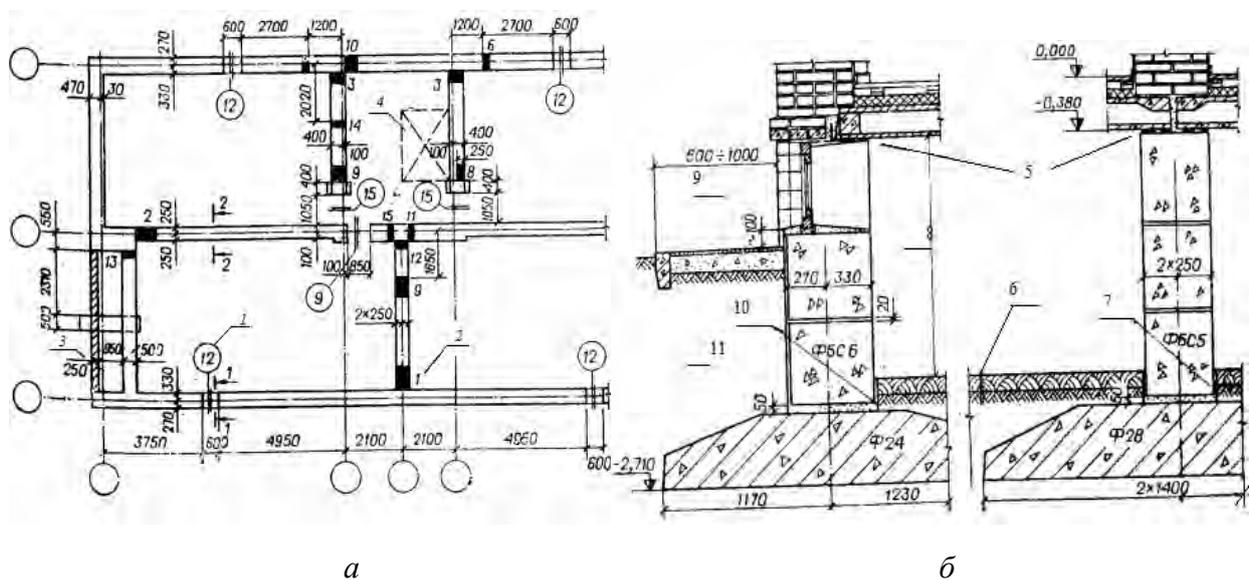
Сборный блочный ленточный фундамент: *а* — план стен технического подвала (подвала); *б* — сечения фундаментов (при уровне грунтовых вод ниже пола подвала): 1 — марки перемычек; 2 — марки отверстий; 3 — кирпичный доколь по ж/б балке; 4 — габарит шахты лифта; 5 — 2 слоя толя или гидроизола на битумной мастике; 6 — глинобетон 100...150, уплотненный грунт; 7 — обмазка горячим битумом (2 раза); 8 — техническое подполье 1900 мм, подвал ≥ 2100 мм; 9 — асфальт 30, щебень ≥ 150 , уплотненный; 10 — обмазка горячим битумом (2 раза); 11 — шов из цементного раствора марки 100, армирован 4• Φ 10
